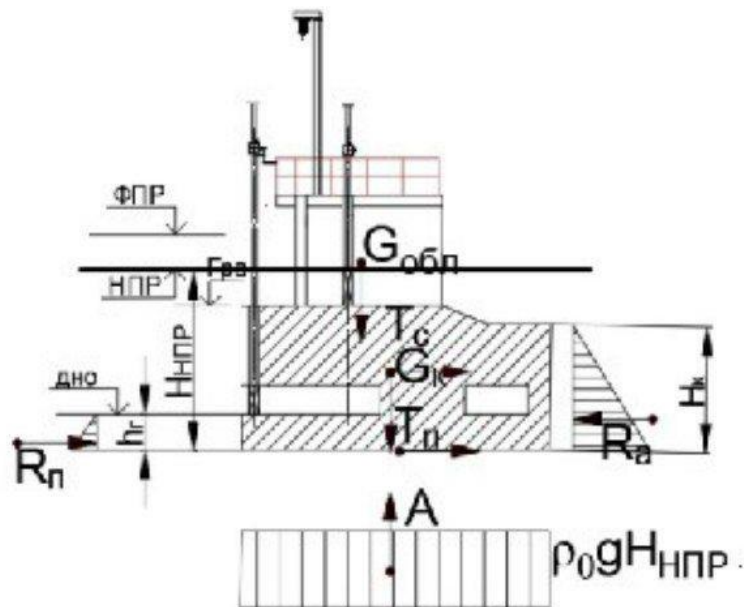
Схема до статичного розрахунку на зсув бокового водозабору.
